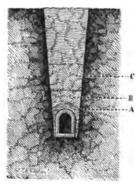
,— Coupe transversale d'un drain construit au moyen de gazons et de pierres.
